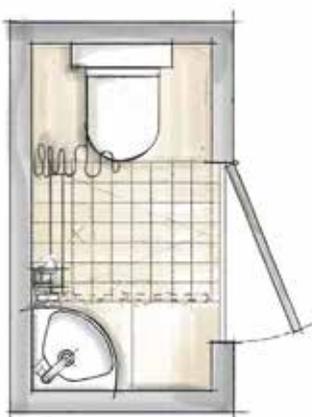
„Best of“ der Grundrissvarianten zur Gästetoilette (Grundriss: DLW)
